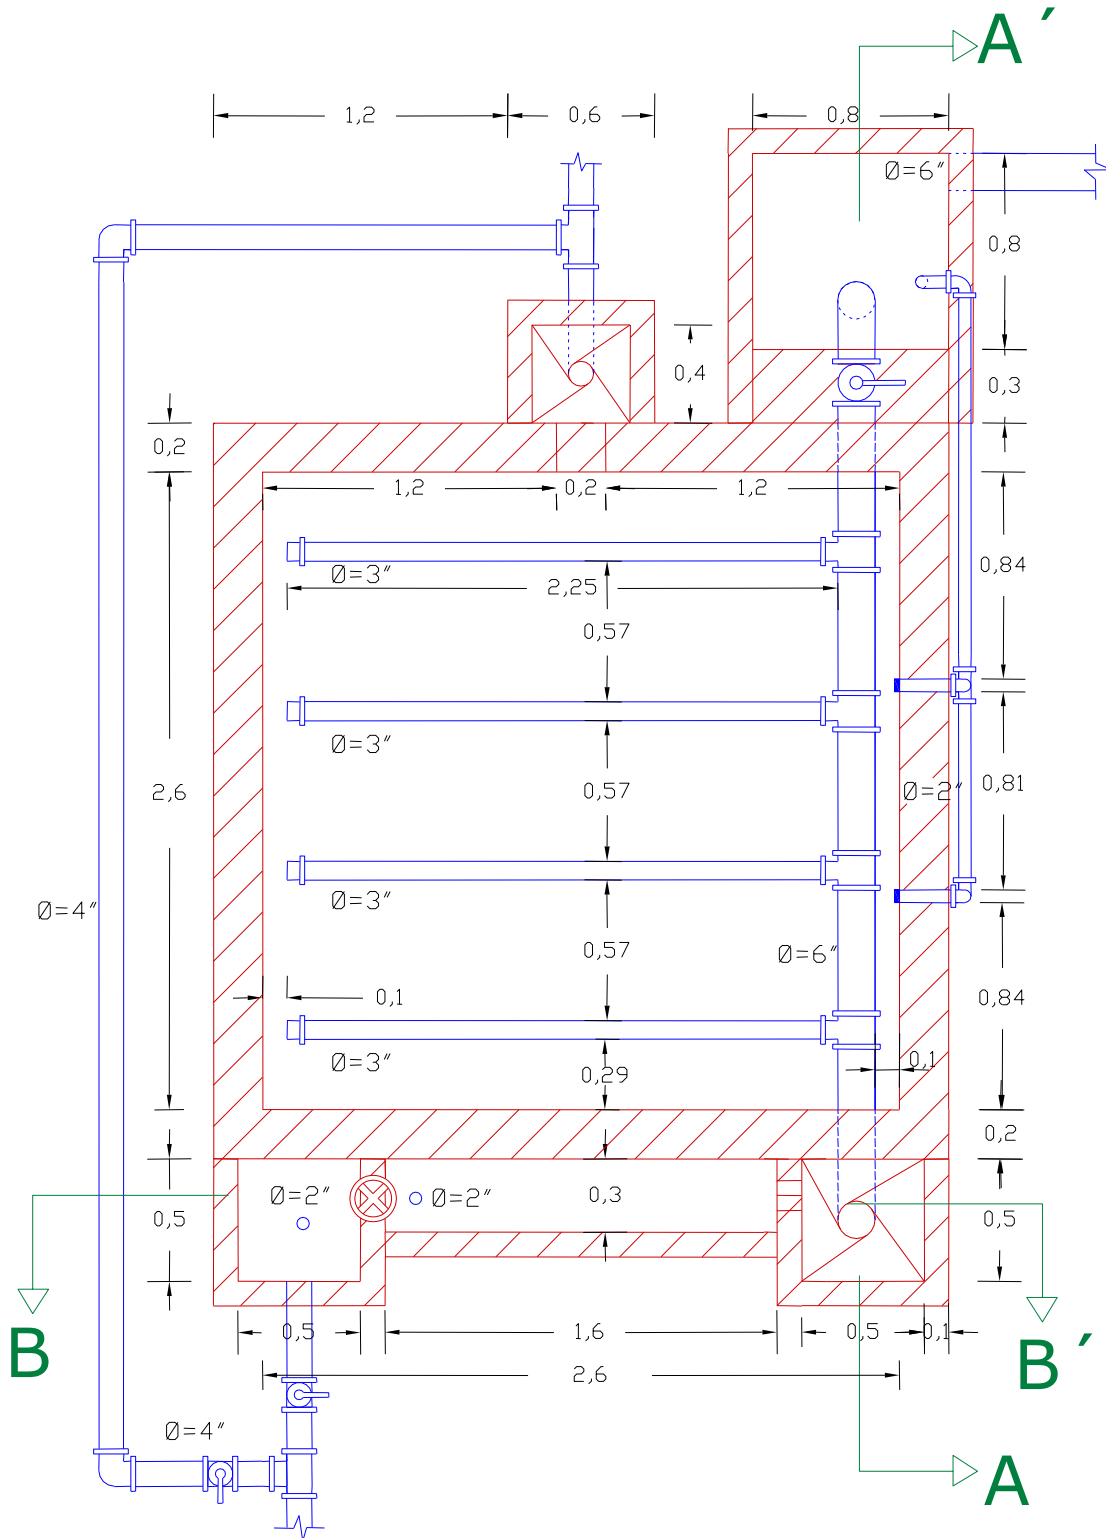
Planta Filtro Grueso de Flujo Ascendente
